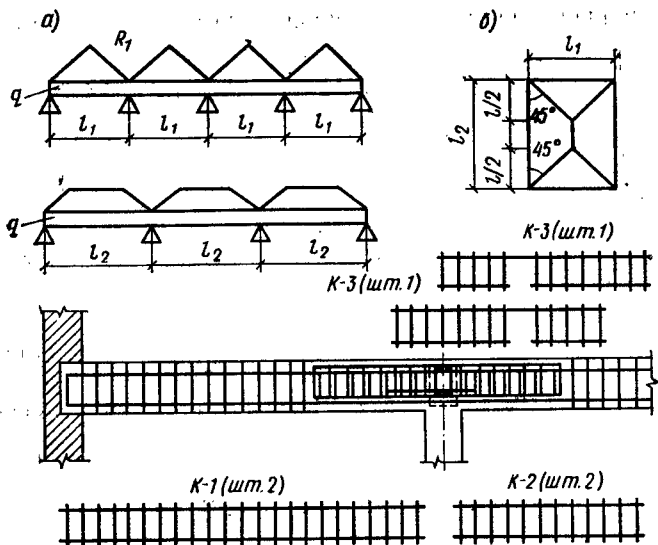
Расчетные схемы и армирование балок ребристых перекрытий с плитами, опертыми по контуру
